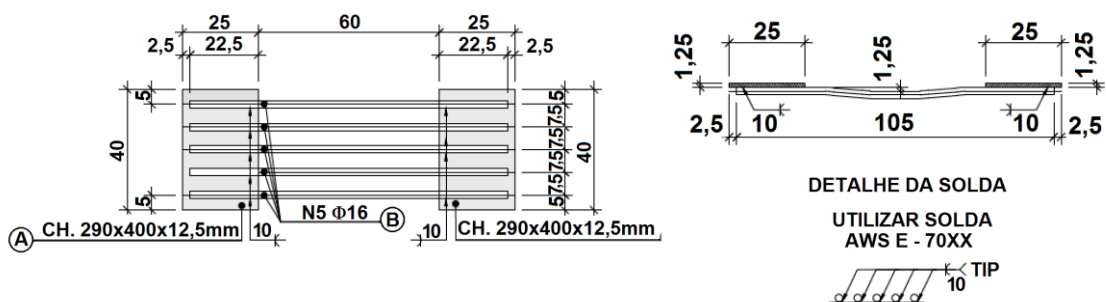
Planta de forma e ferragem de consolos com chapa metálica
